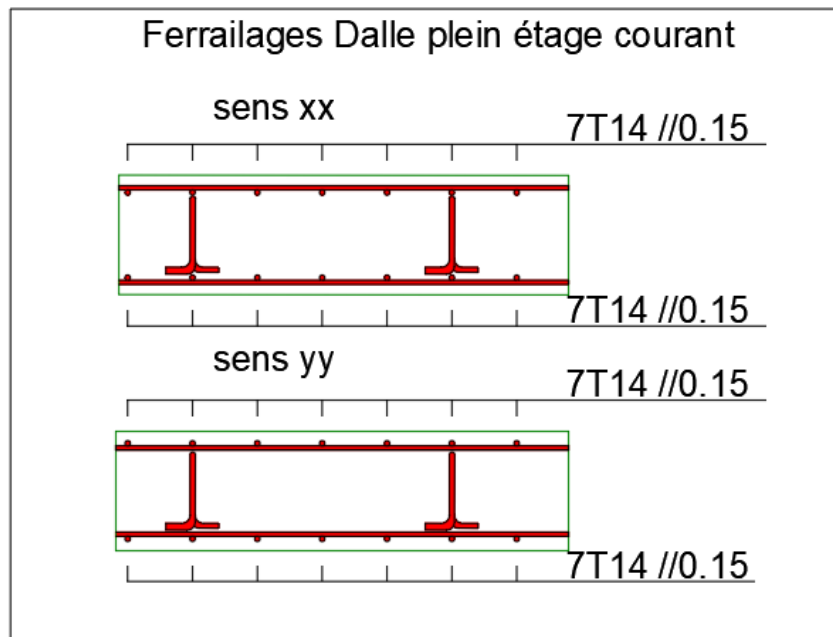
Schéma de ferrailage pour la dalle étage courant.
